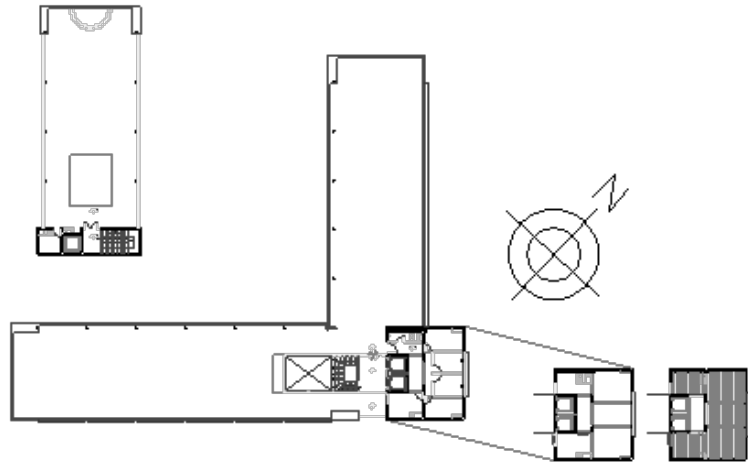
Planta Piso 6 y 7 – Oficinas – Nivel +19,80 hasta +22,55
